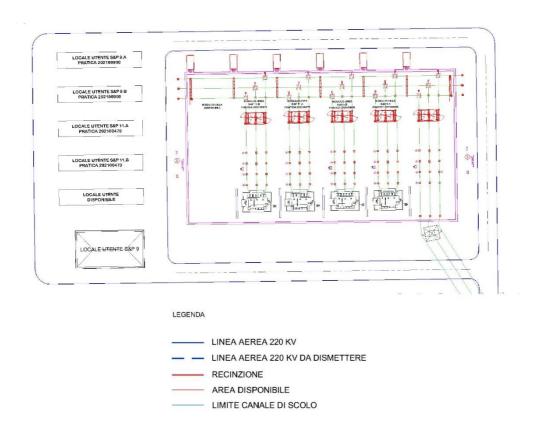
Pianta elettromeccanica generale – Stazione utente
